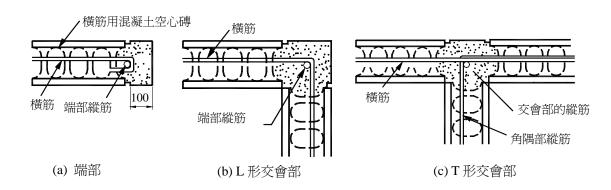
結構牆端部、L形、T形交會部場鑄混凝土施工例
